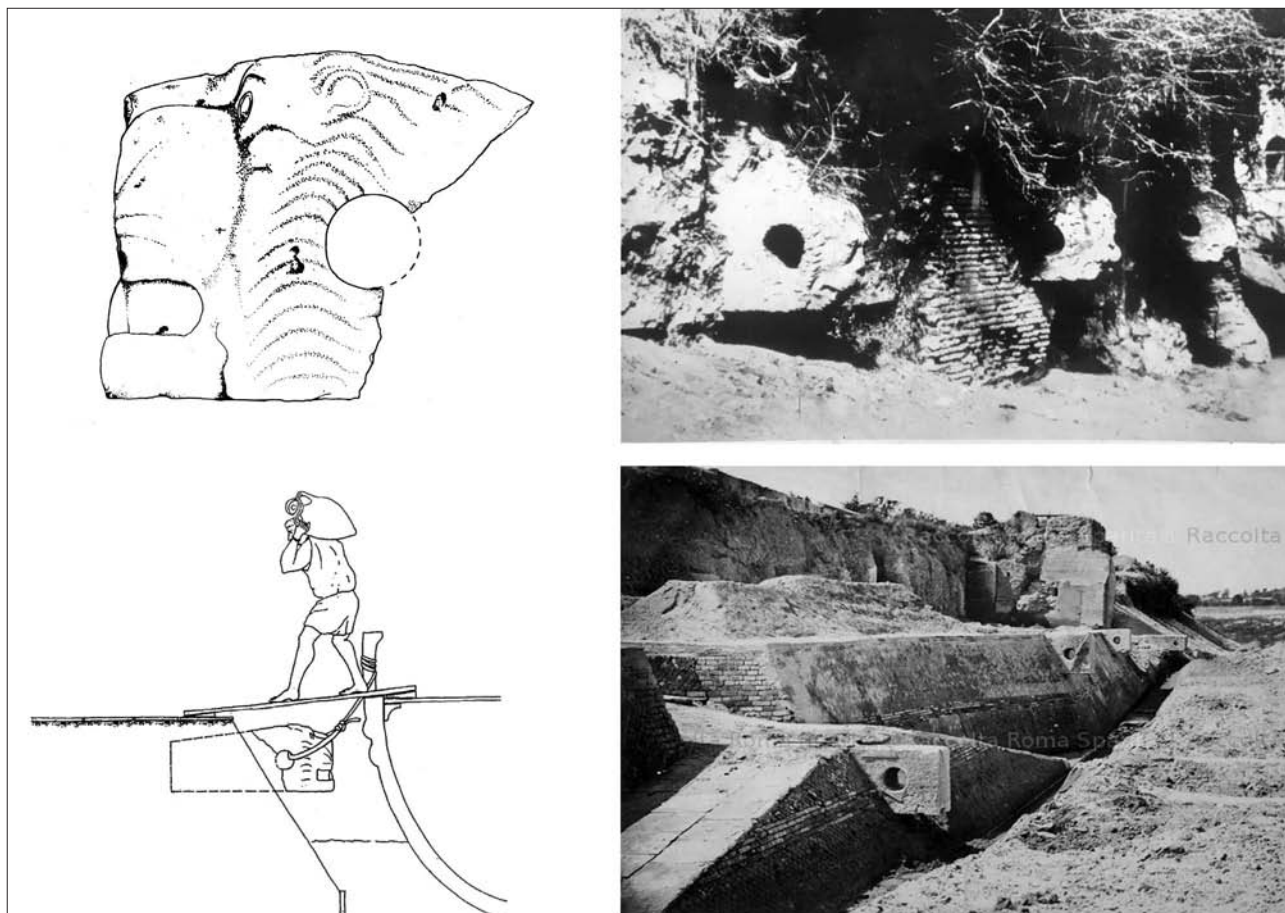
El puerto fluvial de Roma en el *Testaccio*. La excavación descubrió los muelles de atraque de las naves de fondo plano (A) que remontaban el río y que se amarraban a anillas de piedra trabajadas en un bloque de piedra de aprox. 60 cm de altura, con la forma de una cabeza de león. Estaban colocadas justo sobre el nivel del agua (B y C). Los muelles disponían de rampas para acceder a los almacenes. En lo alto de las rampas aparecieron gruesos bloques de piedra con perforaciones circulares.
